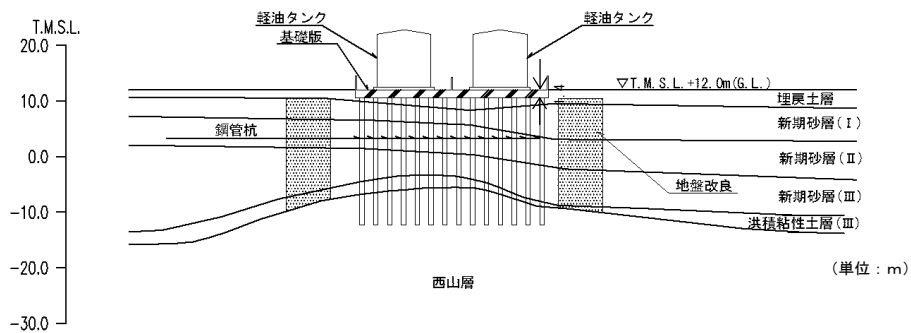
7号炉軽油タンク基礎断面図 (EW 断面)
